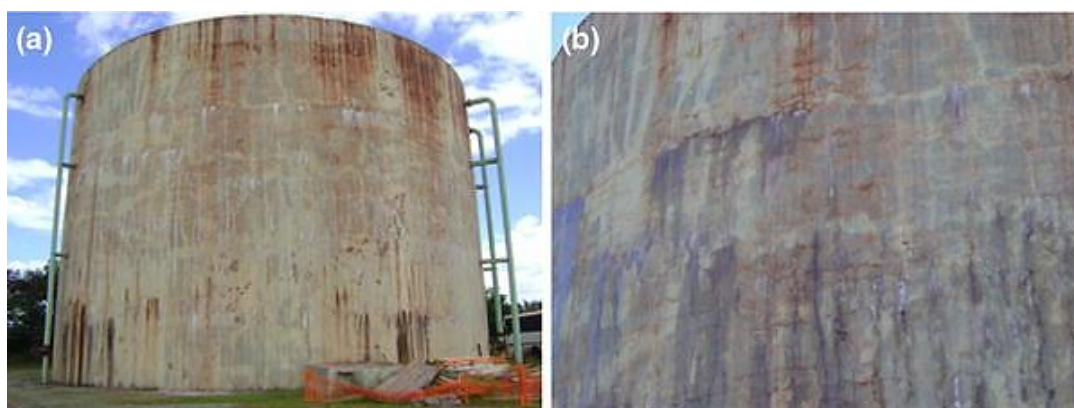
Detalles de la fisuración en la pared del reservorio. (Sollero & Bolorino, 2016)
